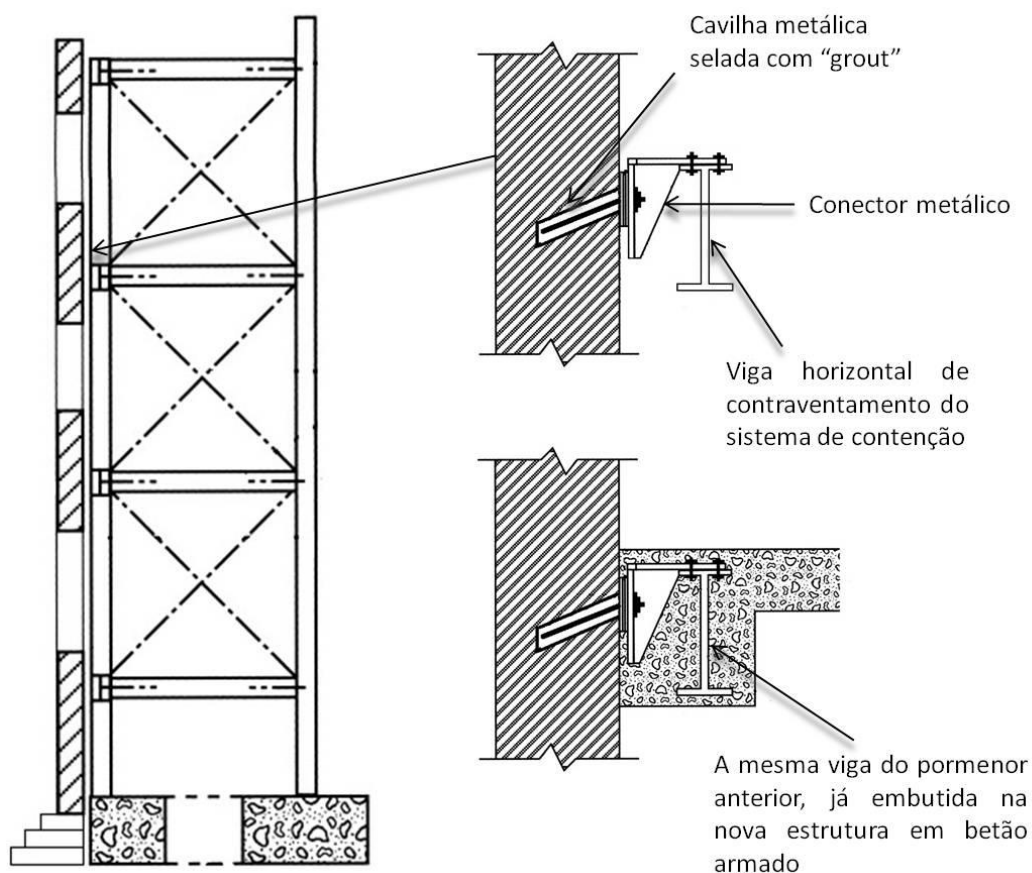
Estrutura de contenção metálica e pormenores de ligação antes e depois da construção da nova estrutura em betão armado, adaptado de [2].
